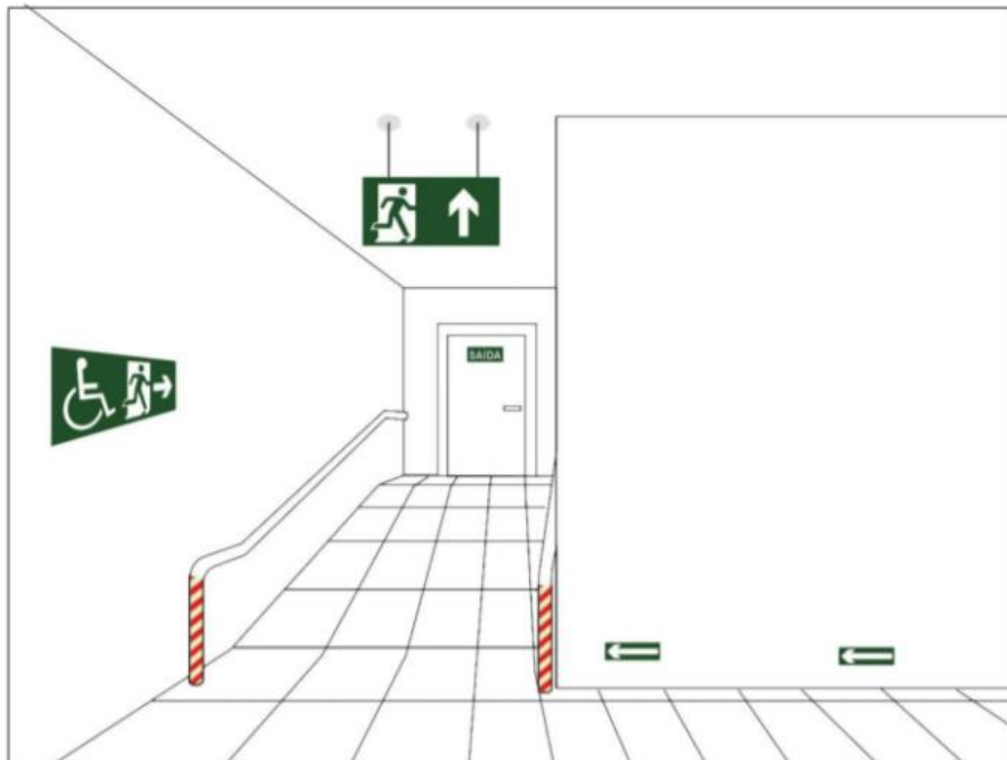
Placas de sinalização de Rota de fuga em rampa.
